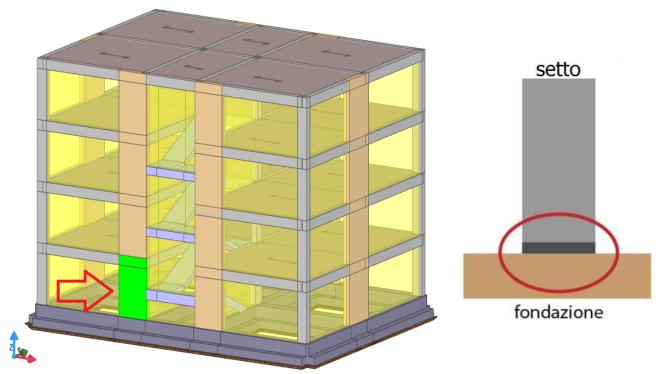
Vista 3D - pilastro oggetto di verifica
